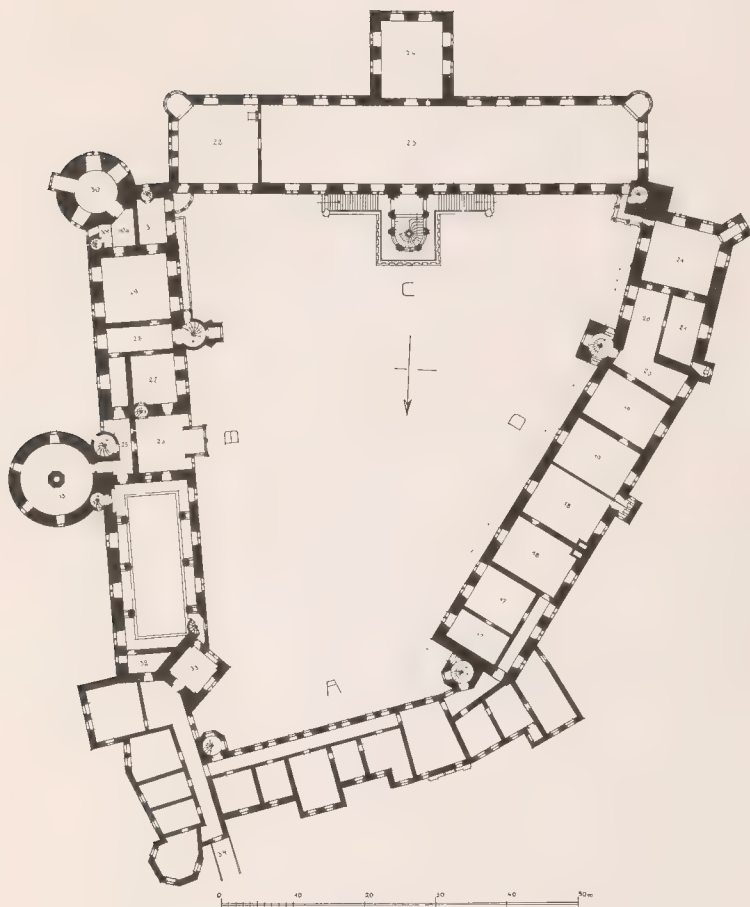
Rekonstruierter Grundriß des ersten Obergeschosses.
